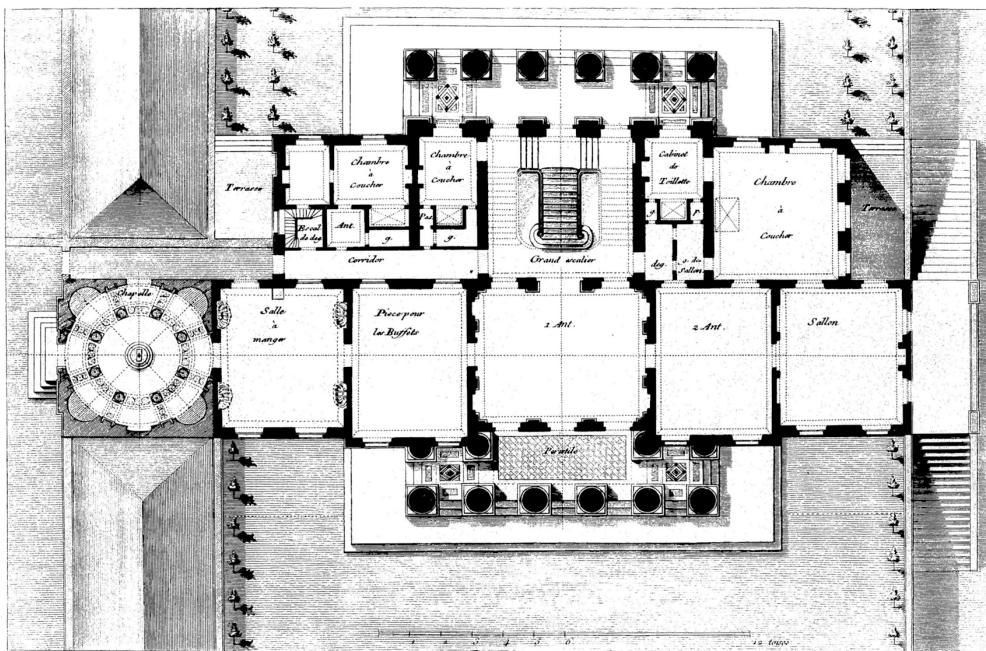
Plans du rez-de-chaussée et du premier étage
